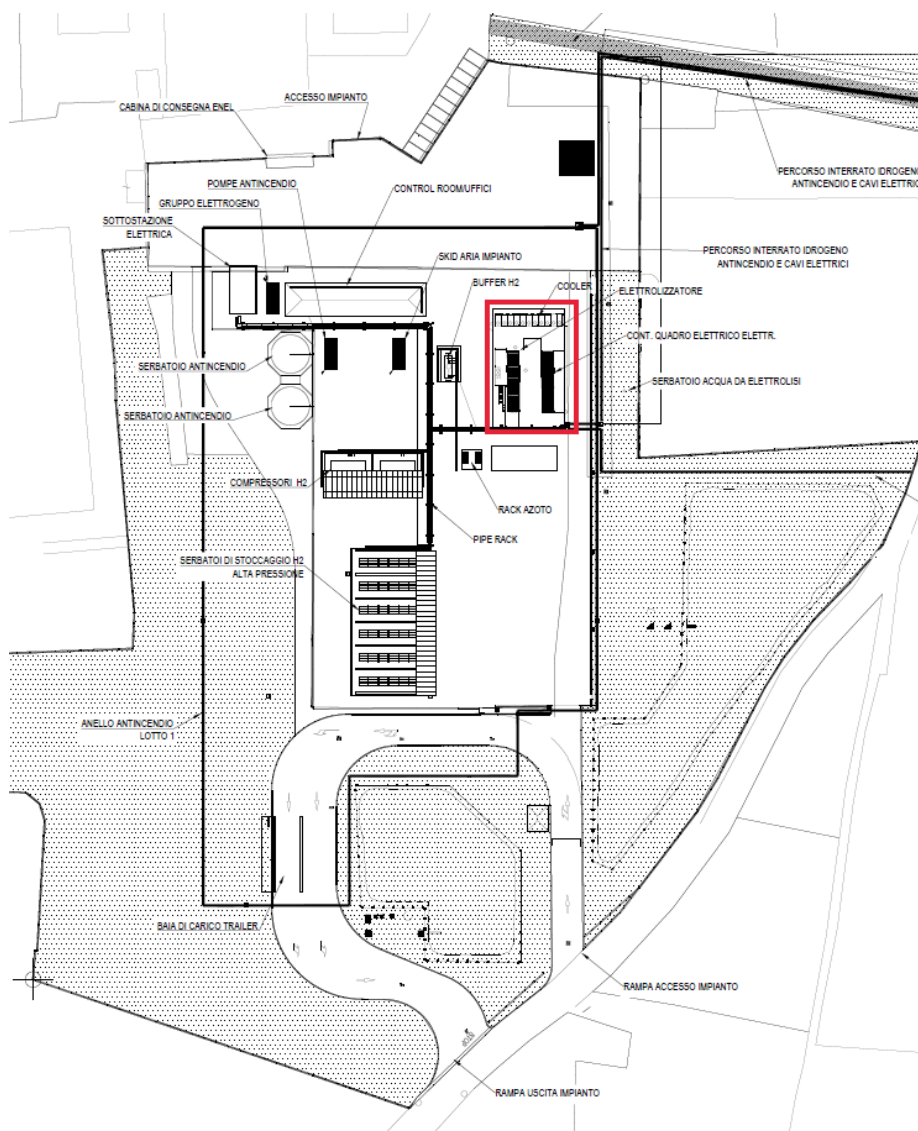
Individuazione planimetrica dell'impianto di elettrolisi nel lotto 1
